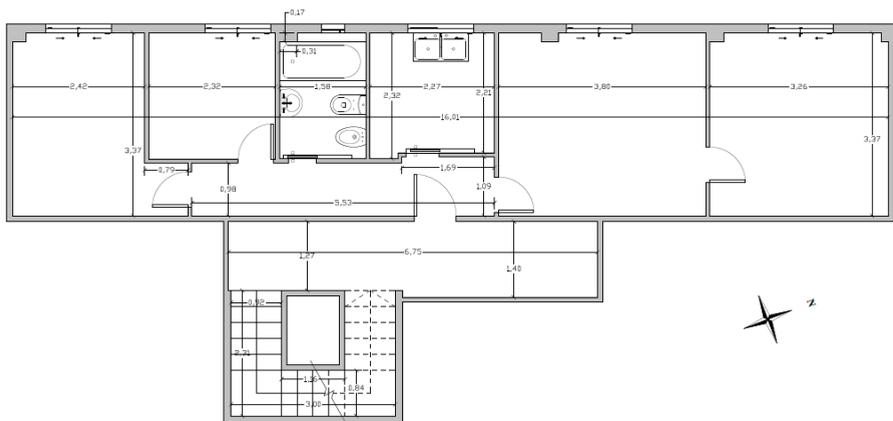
Estado actual de la vivienda. Fuente: Propia.
